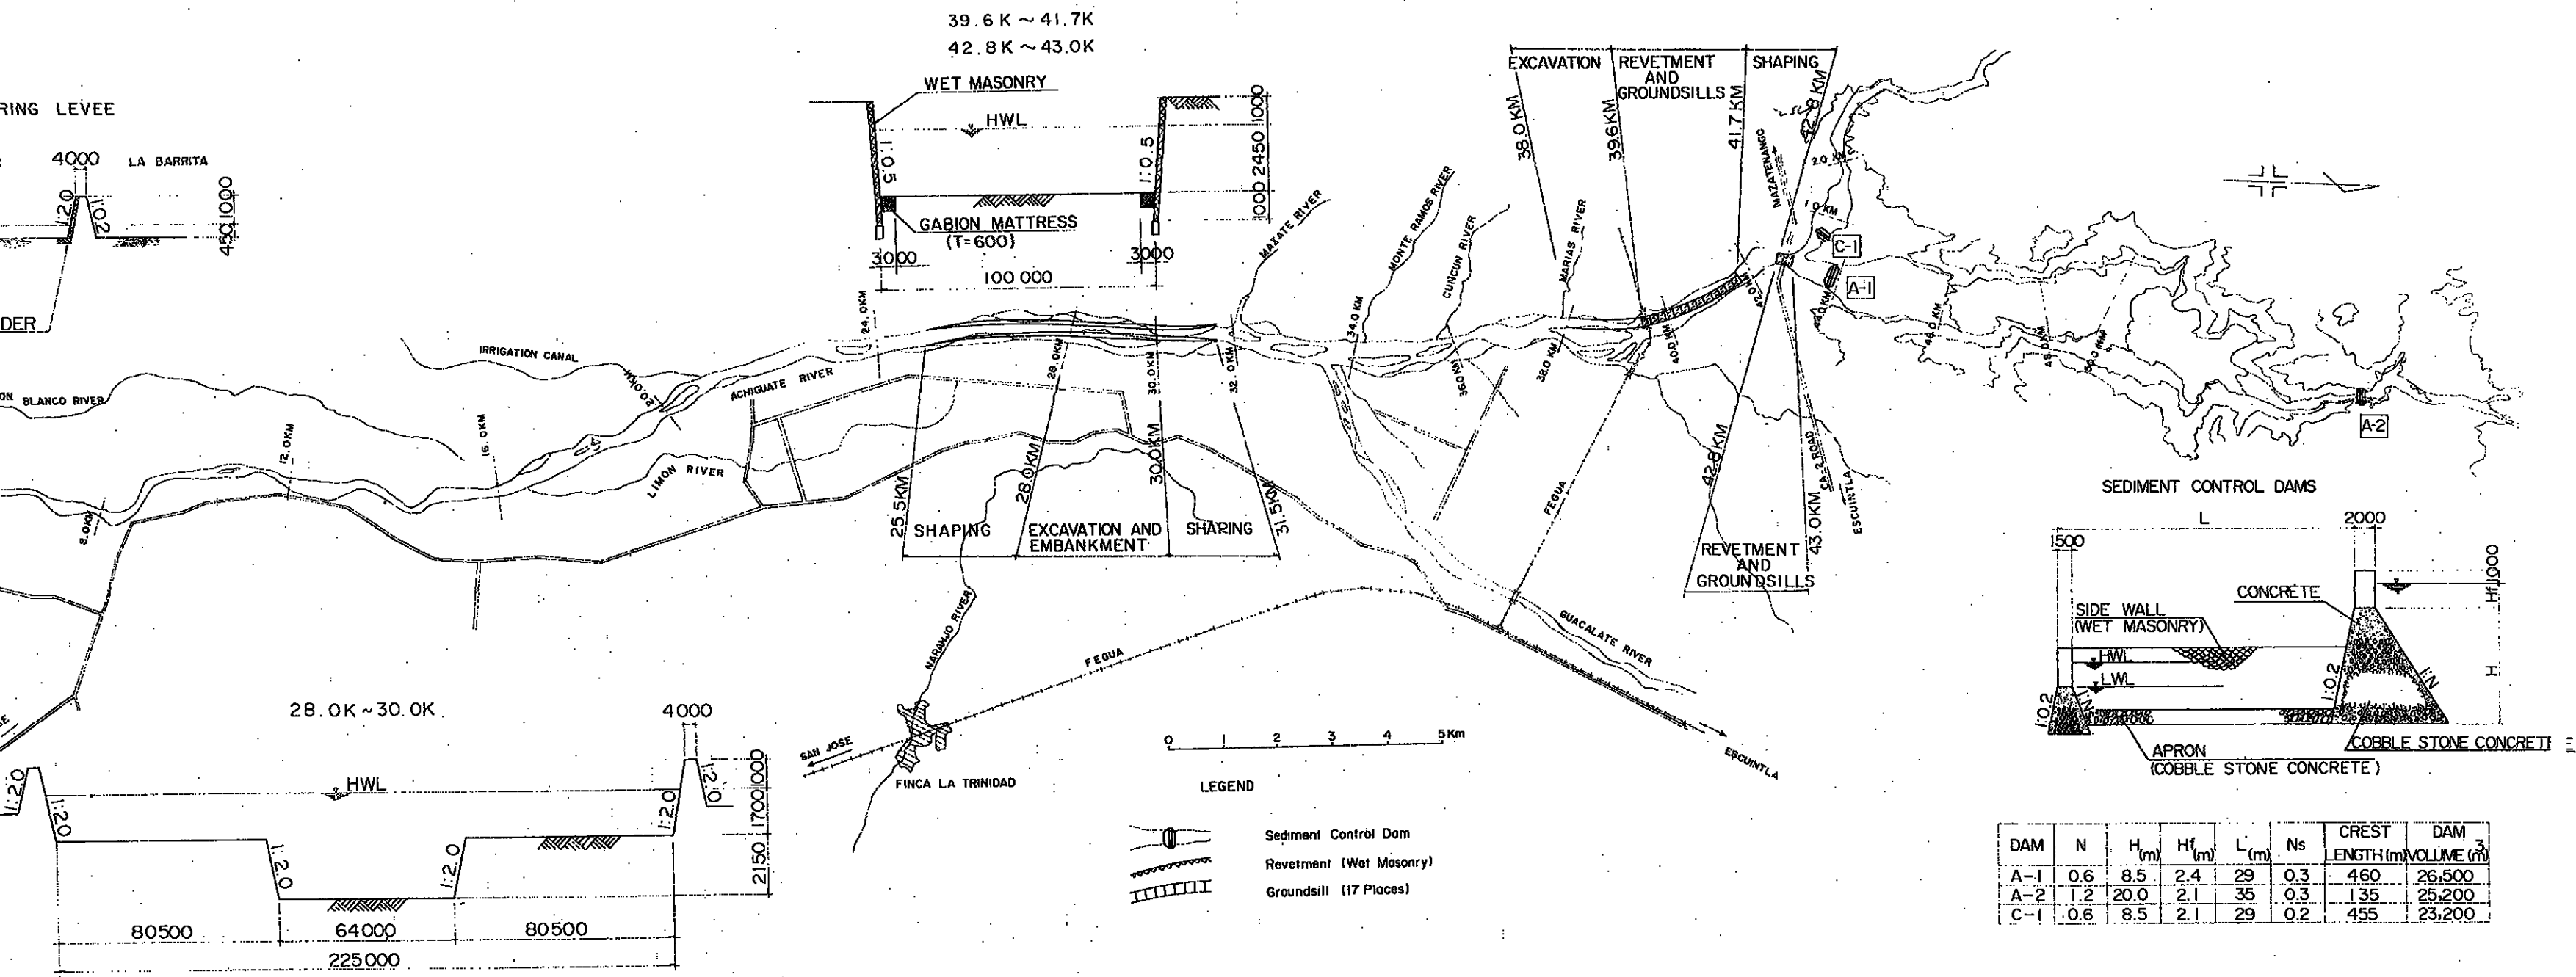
(1/2) PLAN PROPUEST DE PROYECTO A LARGO PLAZO (RIO ACHIGUATE)
